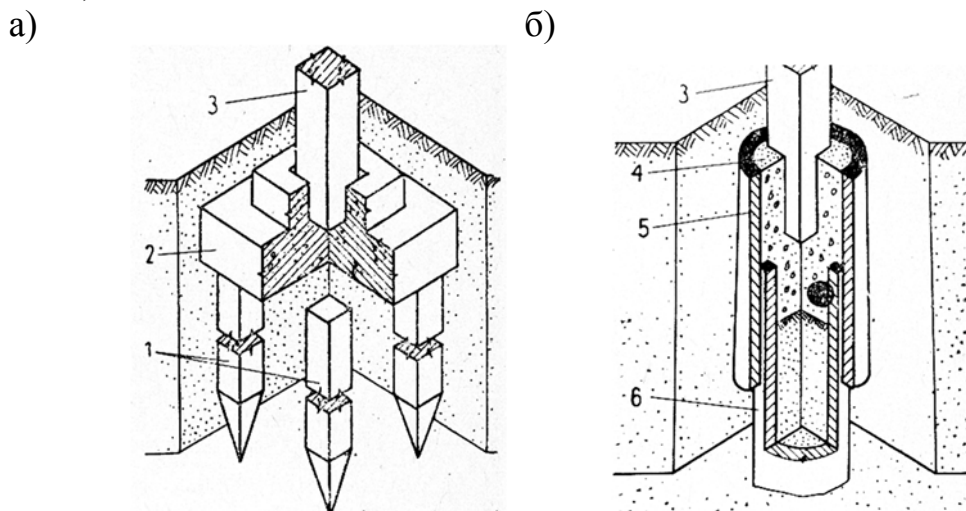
Столбчатые фундаменты на железобетонных сваях:
